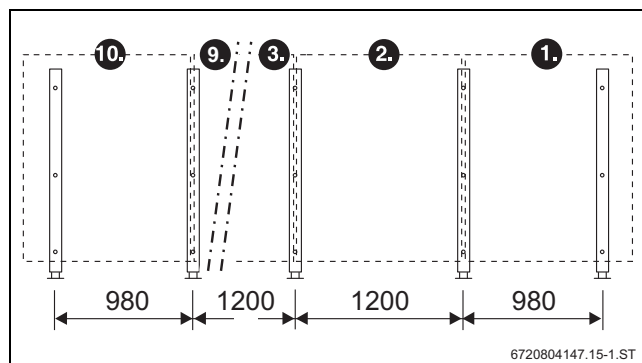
Grundauführung, >3 senkrechte Kollektoren (Maße in mm)
